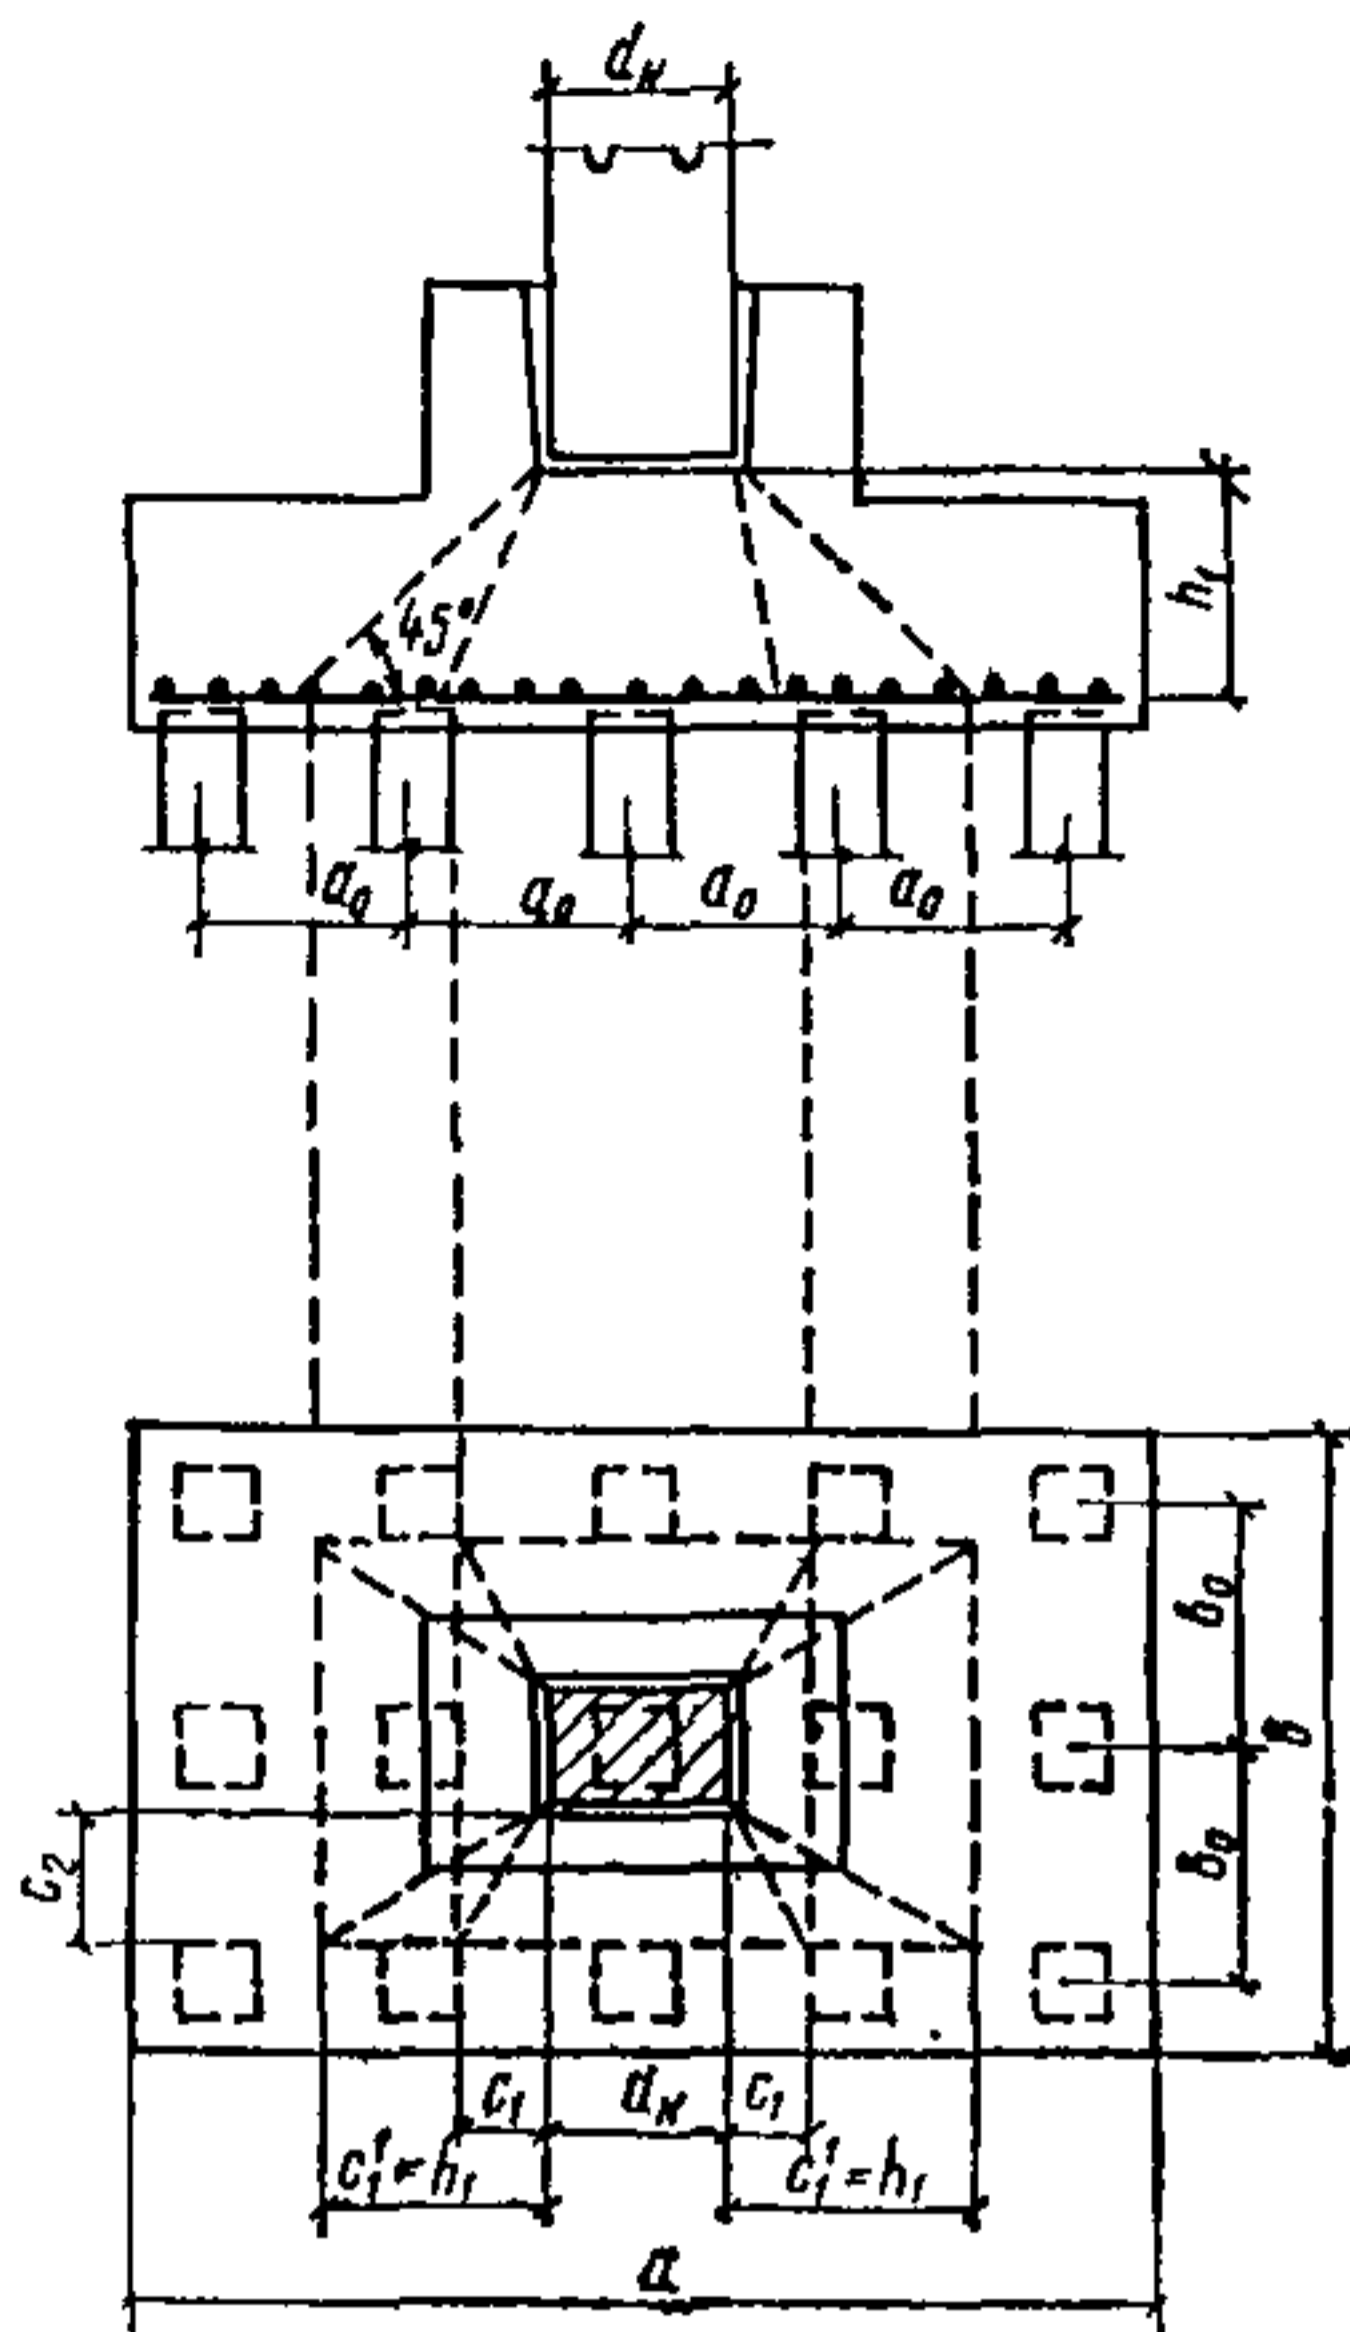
Схема образования пирамид продавливания под сборной железобетонной колонной при многорядном расположении свай за наружными гранями колонны
